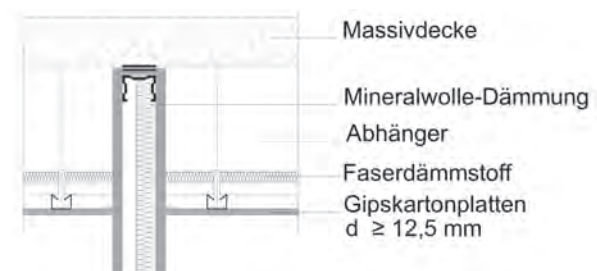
Trennwand durchgehend, raumweise abgehängte Unterdecke (Quelle: Baradiy)
